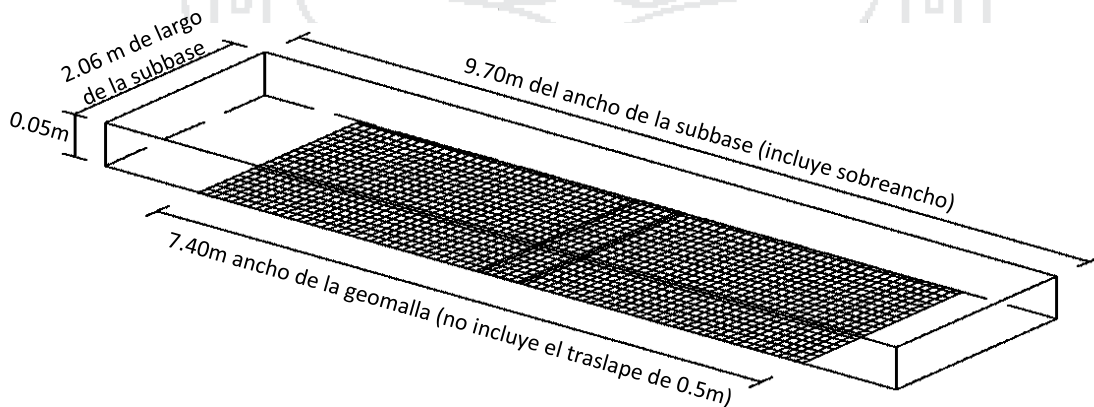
Corte de la sección típica del pavimento de la carretera DV. Huancané – Chupa
